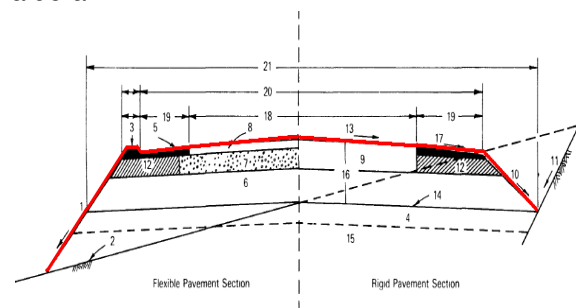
Detalle de una sección de carretera (Fuente:AASHTO)
